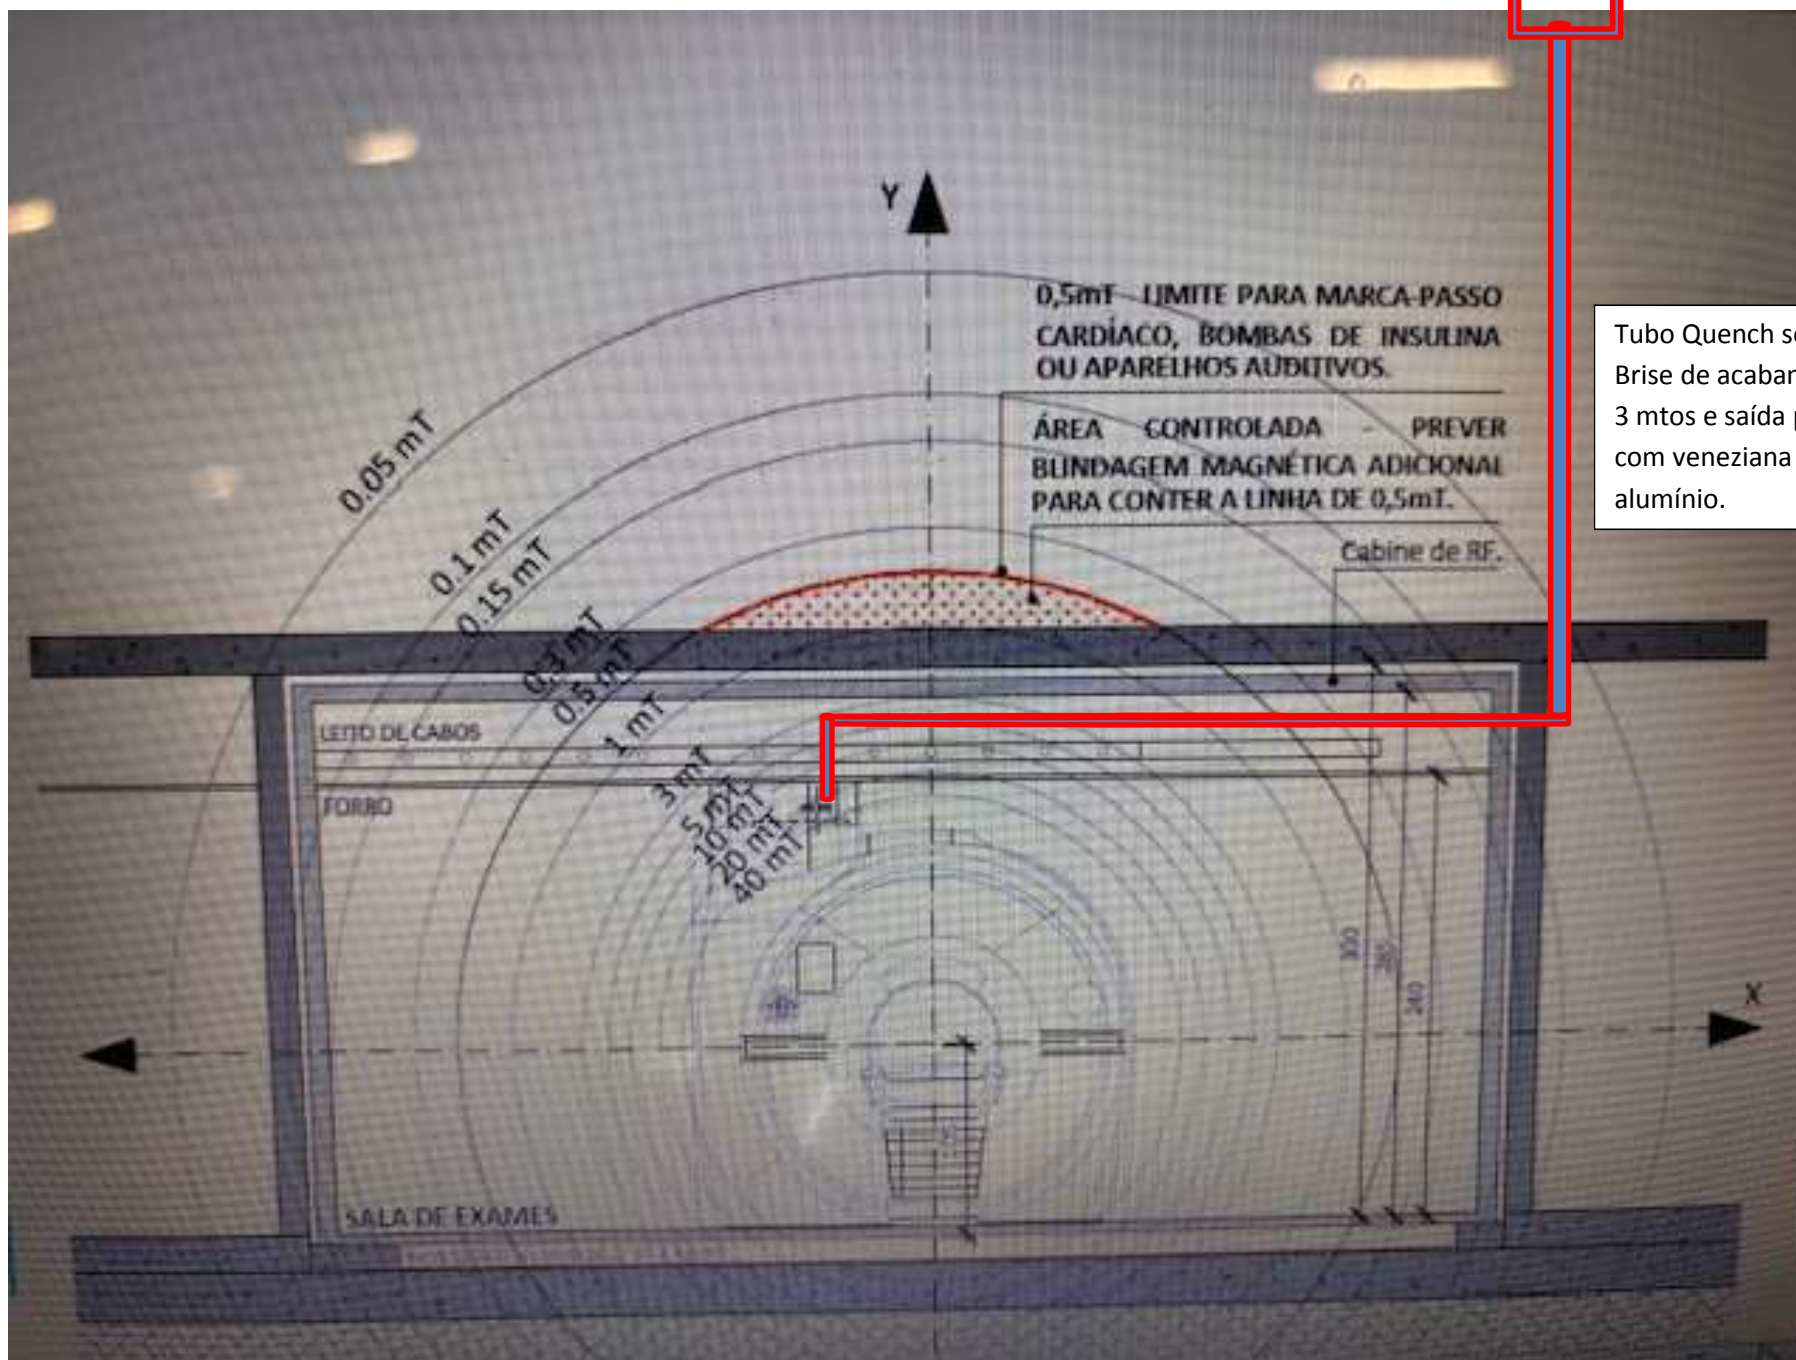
Detalhe do andar inferior diretamente abaixo da sala de exames onde deverá ser instalada estrutura para posicionar chapas de Silício.
